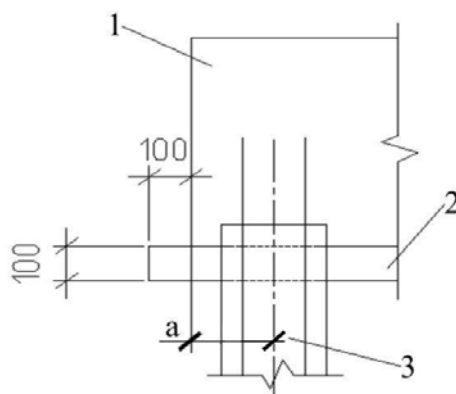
Схема определения расстояния (a) от оси НРСн до края фундамента: 1- фундамент; 2- бетонная подготовка; 3- НРСн.
